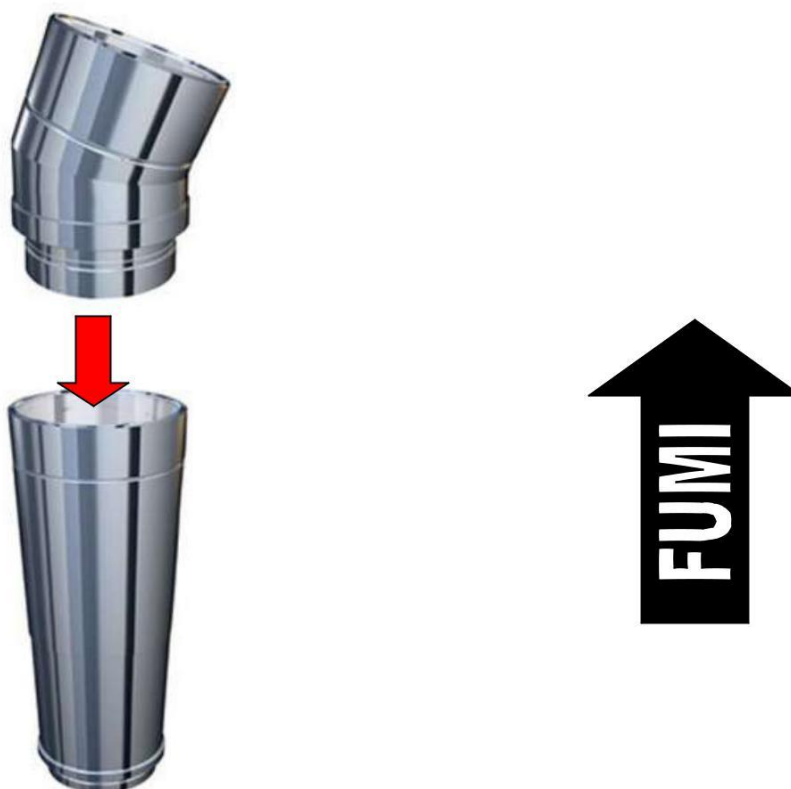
Esempio di innesto maschio-femmina e direzione fumi da rispettare
